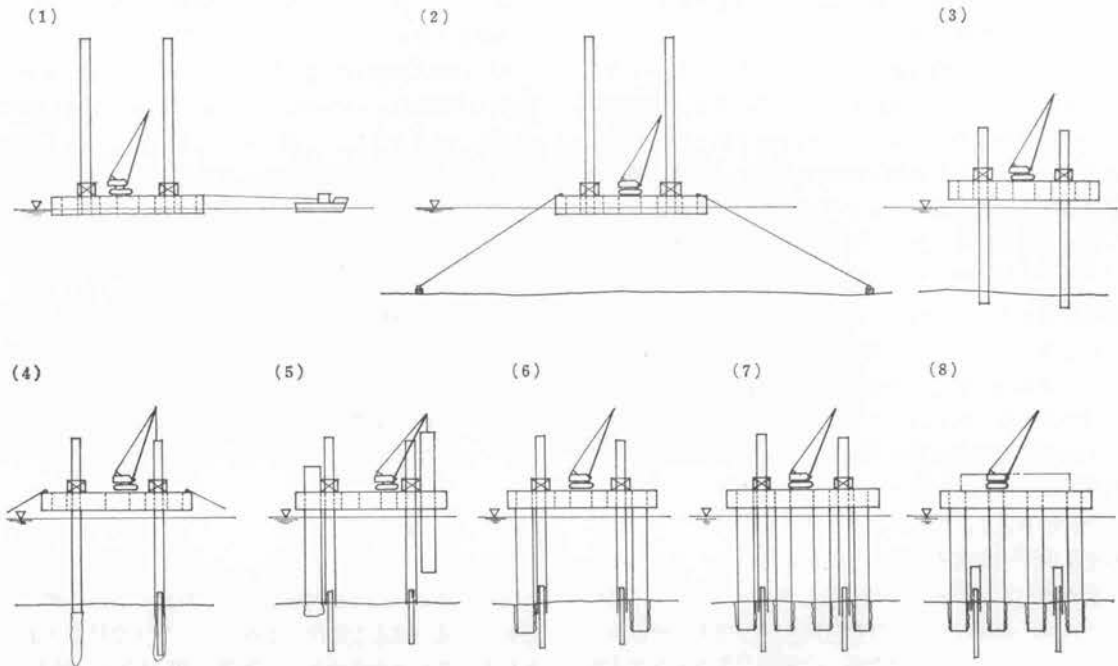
多柱式基礎施工順序図(頂版ジャッキアップ案)
